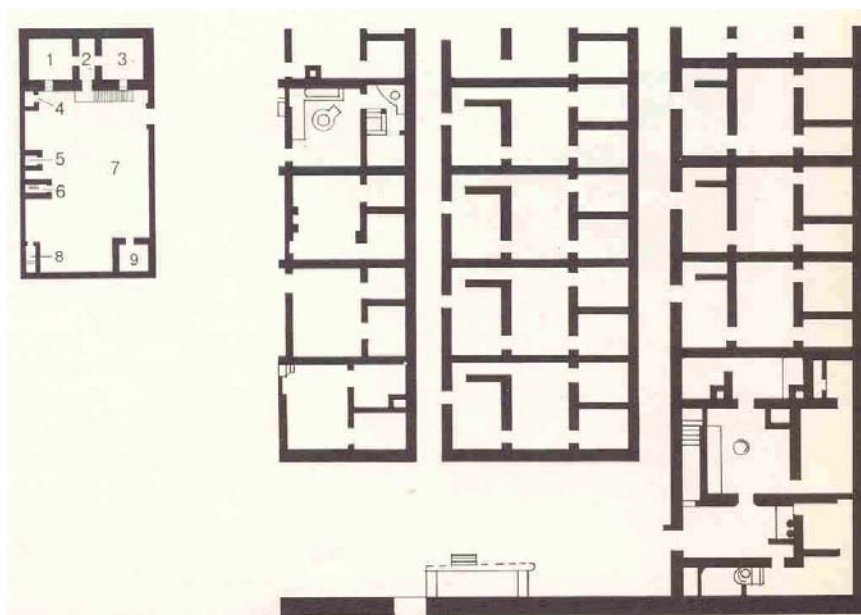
Planta de la ciutat de Tell-el-Amarna i planta d'una casa típica
